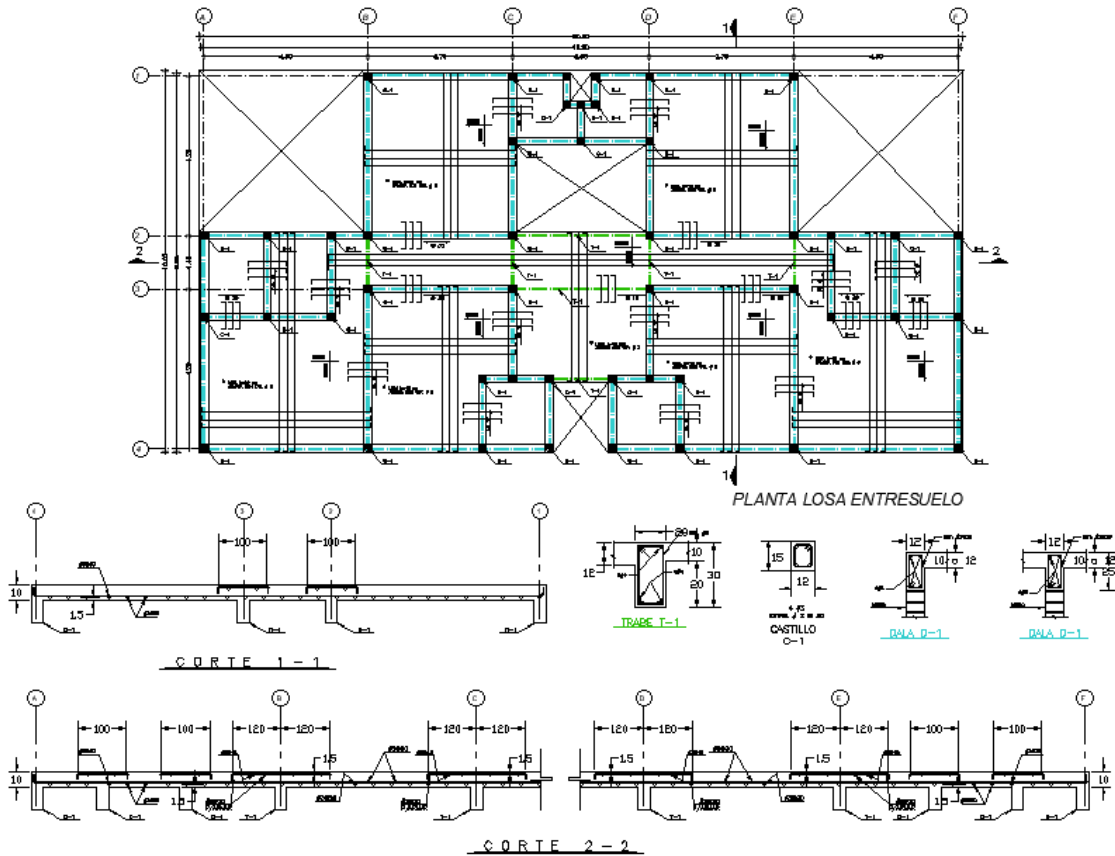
Planta de losa de entresuelo del proyecto estructural. Autoría propia.
